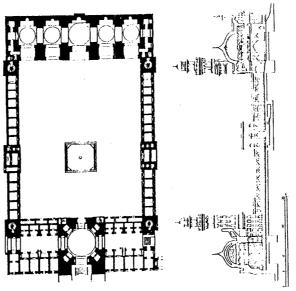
مسقط أفقي لجامع نايين . (عن:بوب) .
